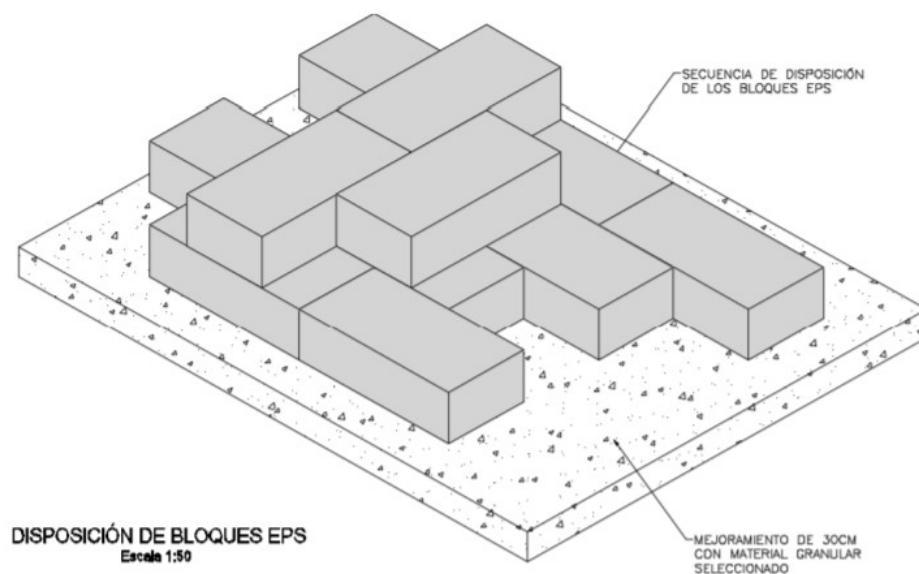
Detalle de la disposición de los bloques en capas durante la construcción.
